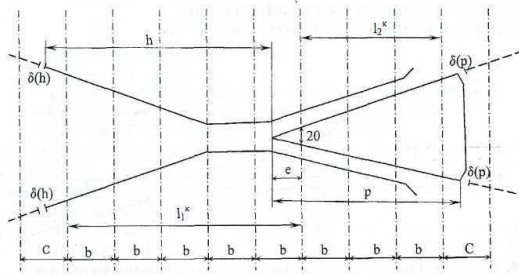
Расчетная схема раскладки переходных брусьев в пределах крестовины
